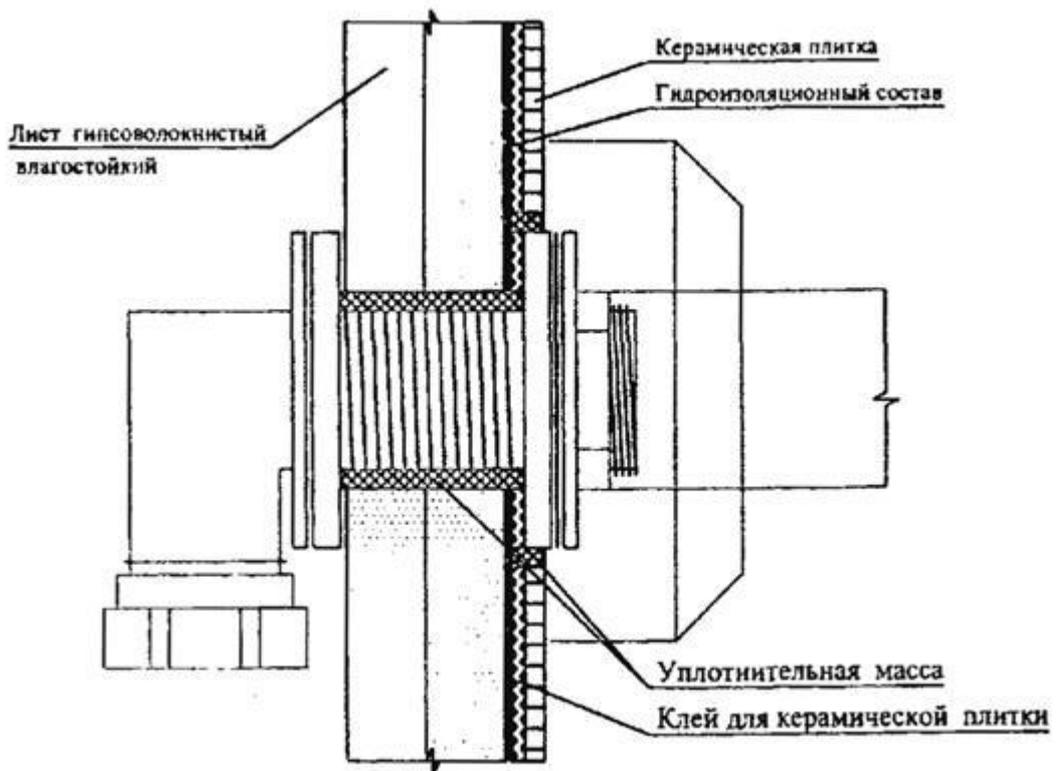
Схема закрепления трубопровода к обшивке перегородки из гипсоволокнистых листов
